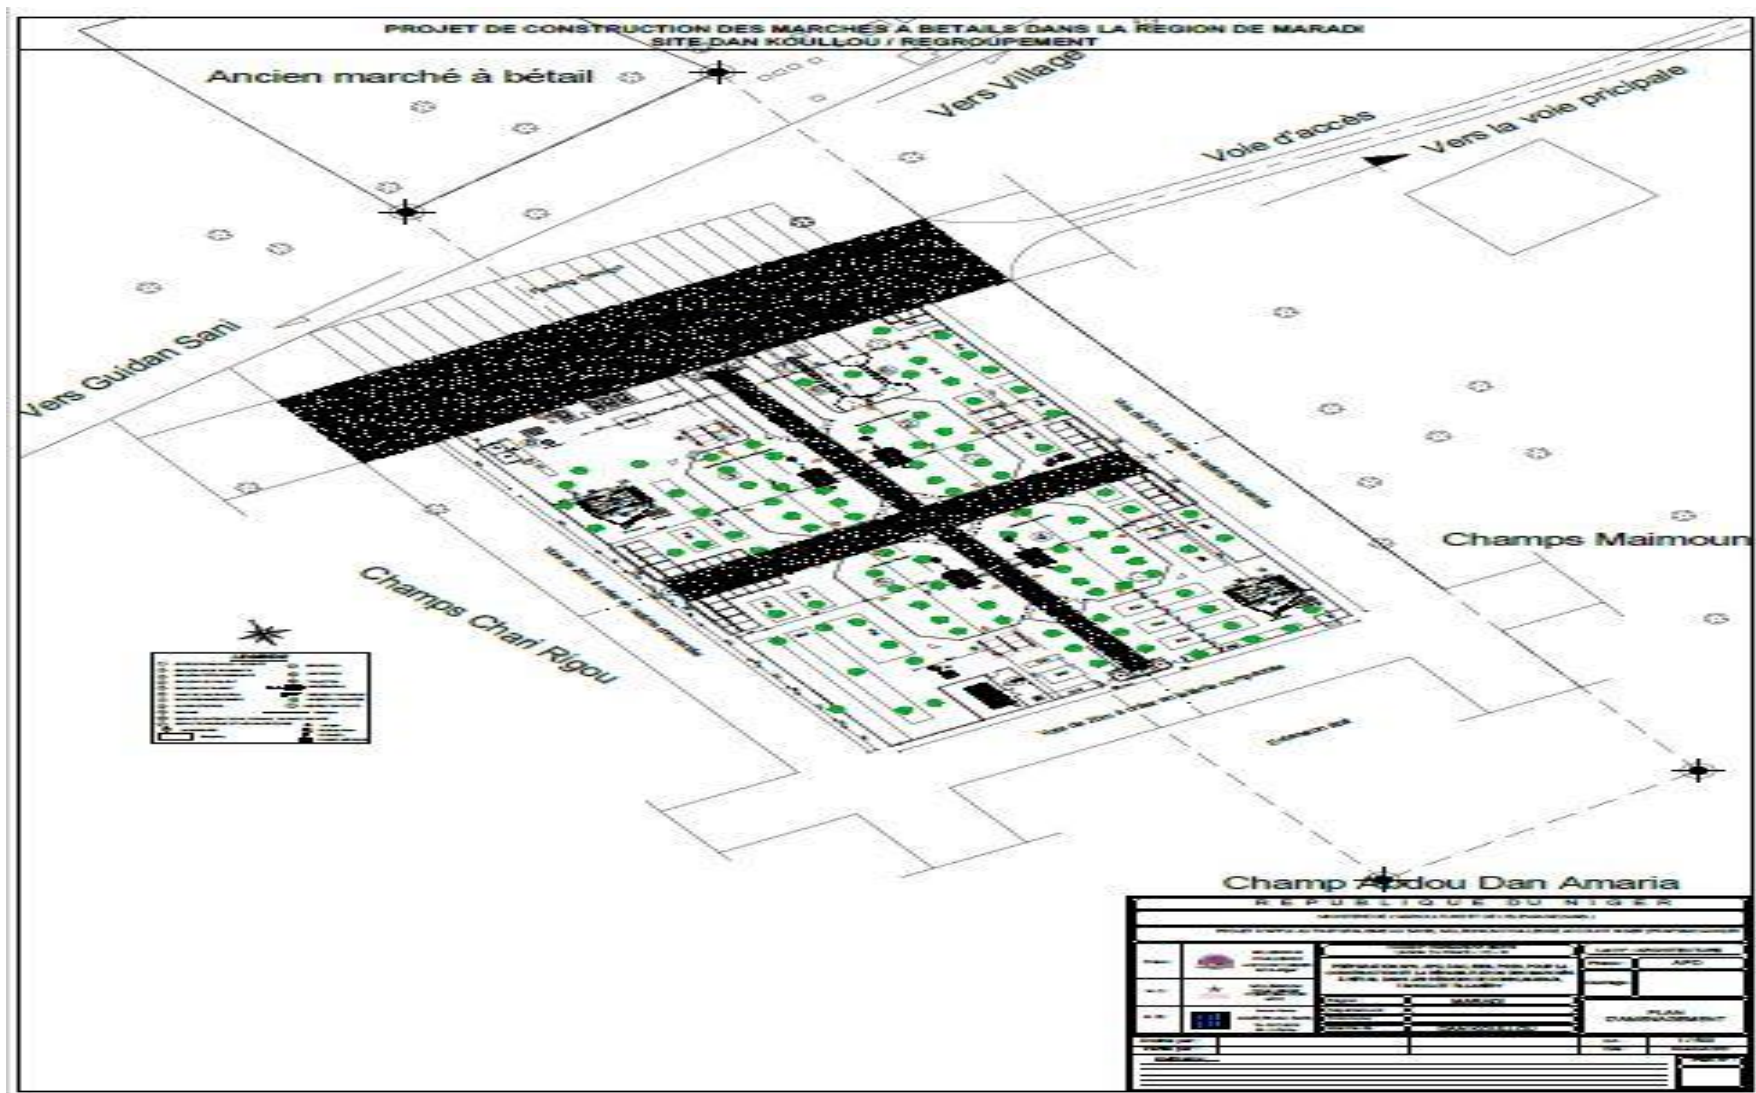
Plan de masse et d'aménagement du marché de Dankoulou
